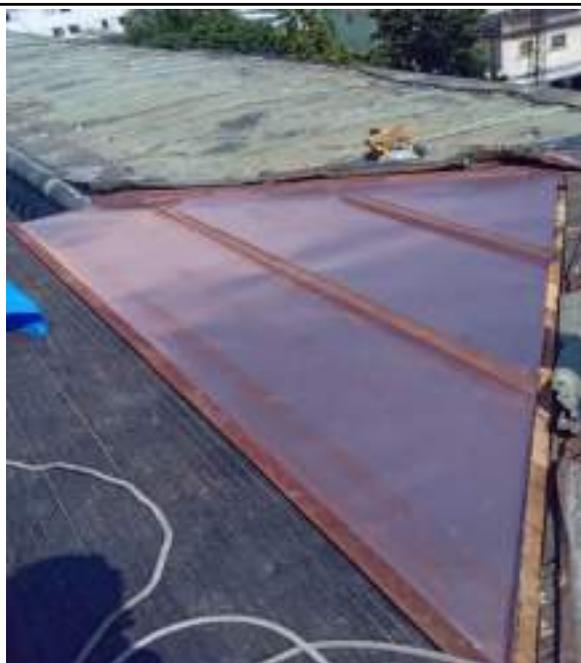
Atividade de conservação da cobertura, instalação das telhas em cobre.
